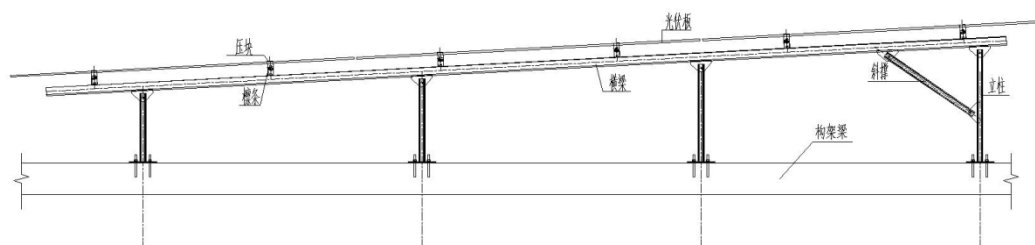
混凝土构架层化学锚栓加光伏支架示意图
